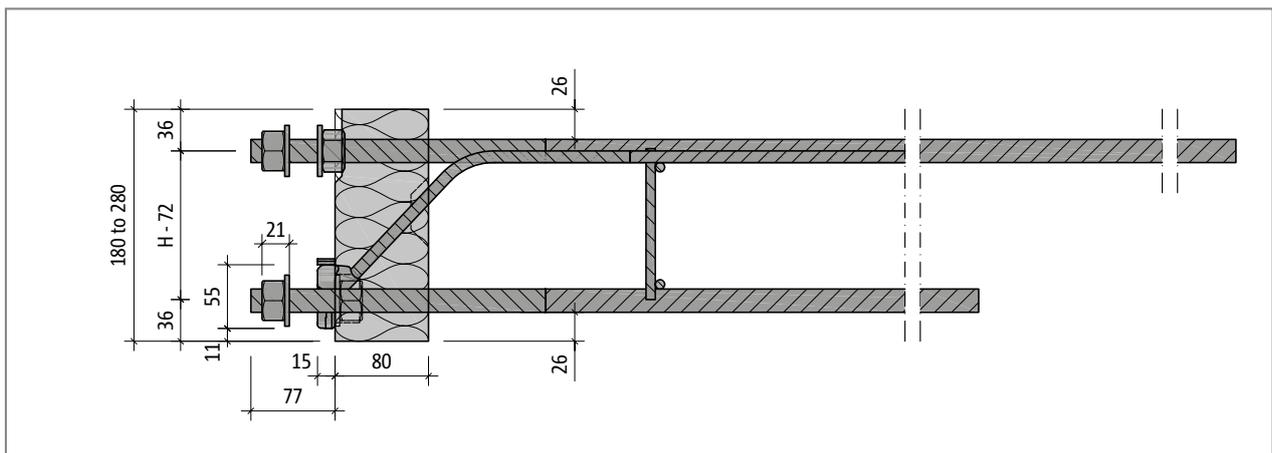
Schöck Isokorb® T type SK-MM2-VV1: Cross section of the product
